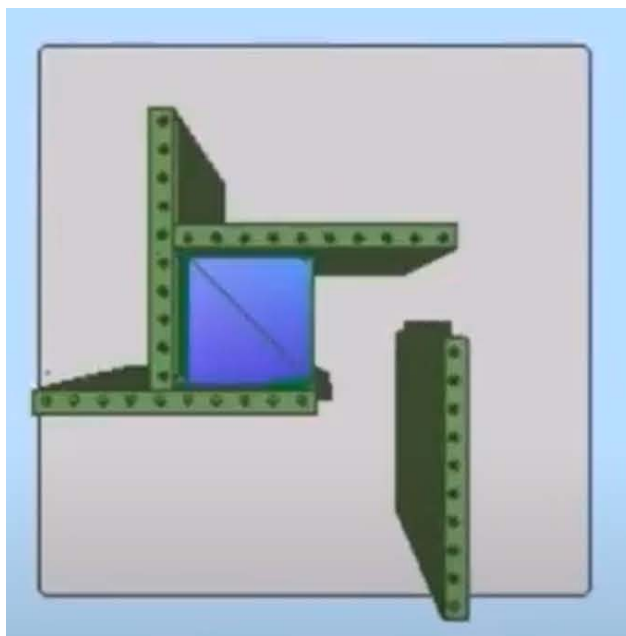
Imagen ilustrativa de la colocación de la cimbra de contacto vista en planta.
